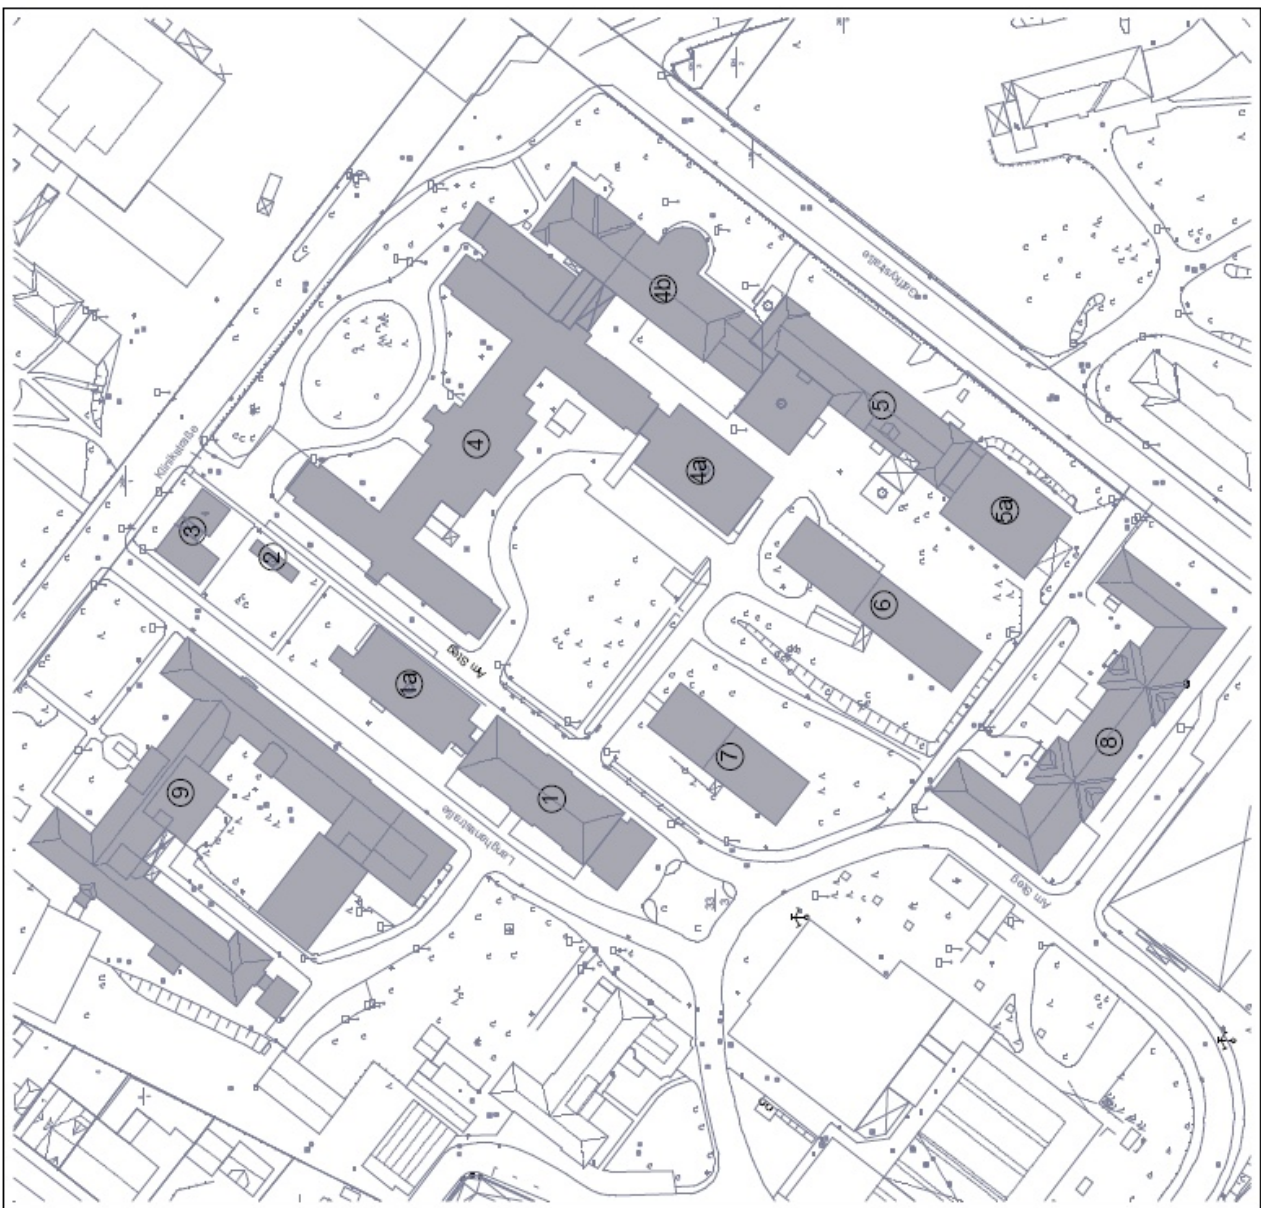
Übersichtsplan mit Nutzungen im Gebäudebestand, Büro BLFP/8-2010
